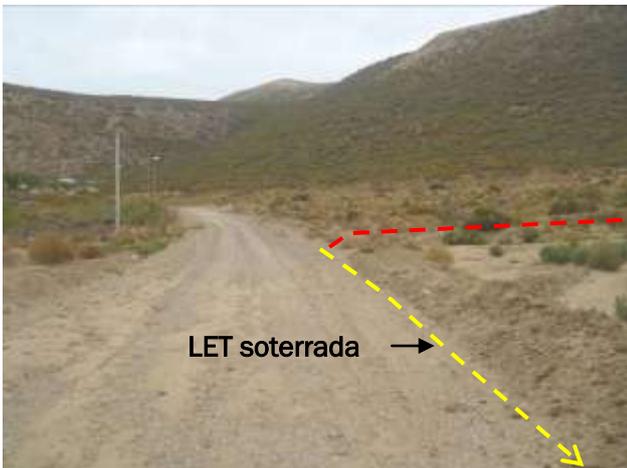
Detalle de la zona de emplazamiento de LET irá soterrado (amarillo). Foto en dirección N.
